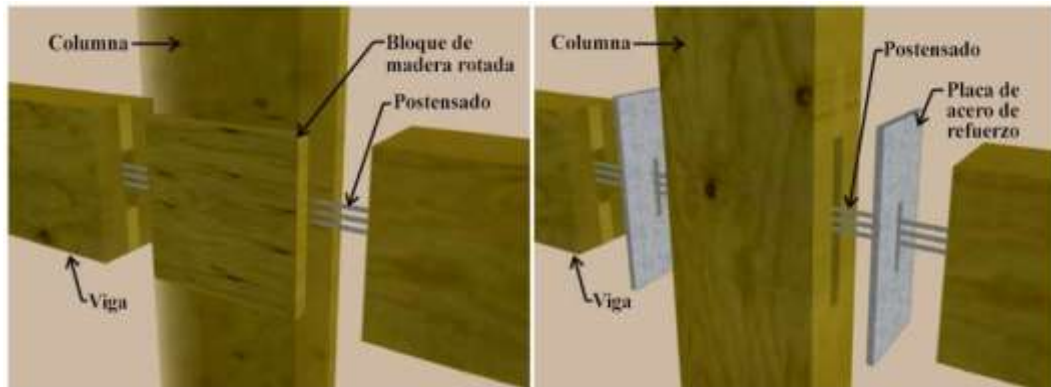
Reforzamiento de columna (Newcombe, 2011). a) Tipo 02, b) Tipo 03.
